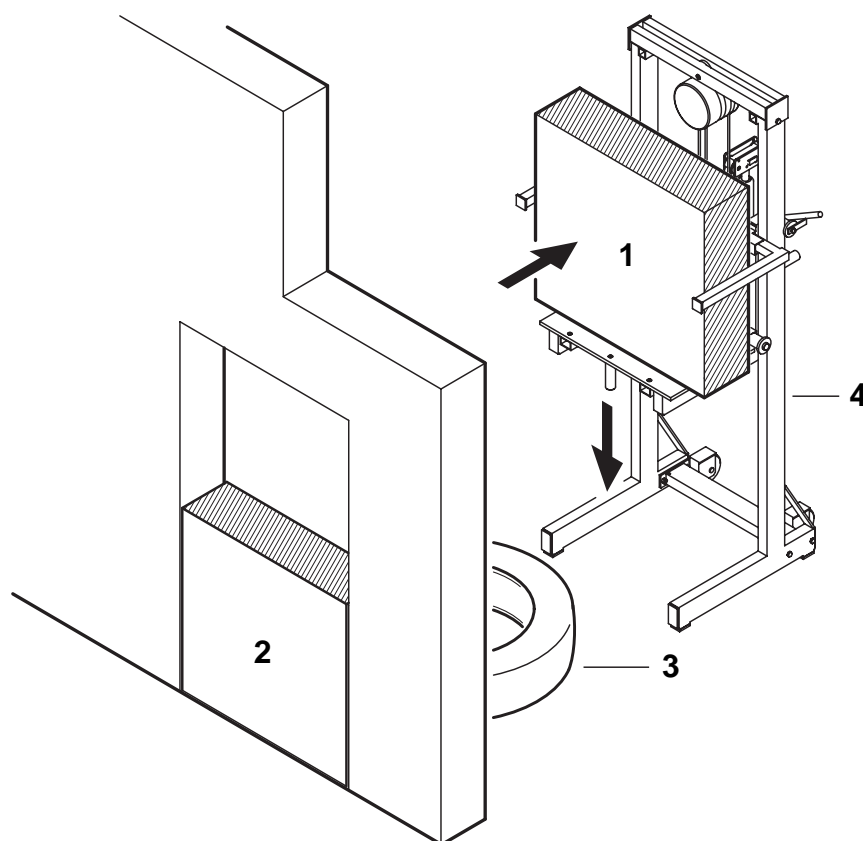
Uttak av veggutsnitt med betongblokkløfter
